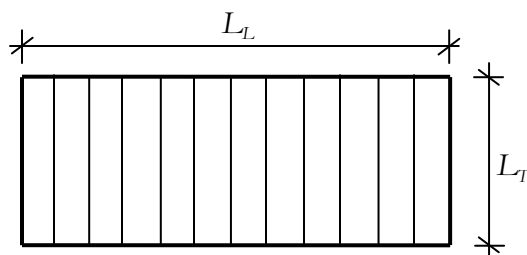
Vãos longitudinal e transversal da escada (vista em planta)
